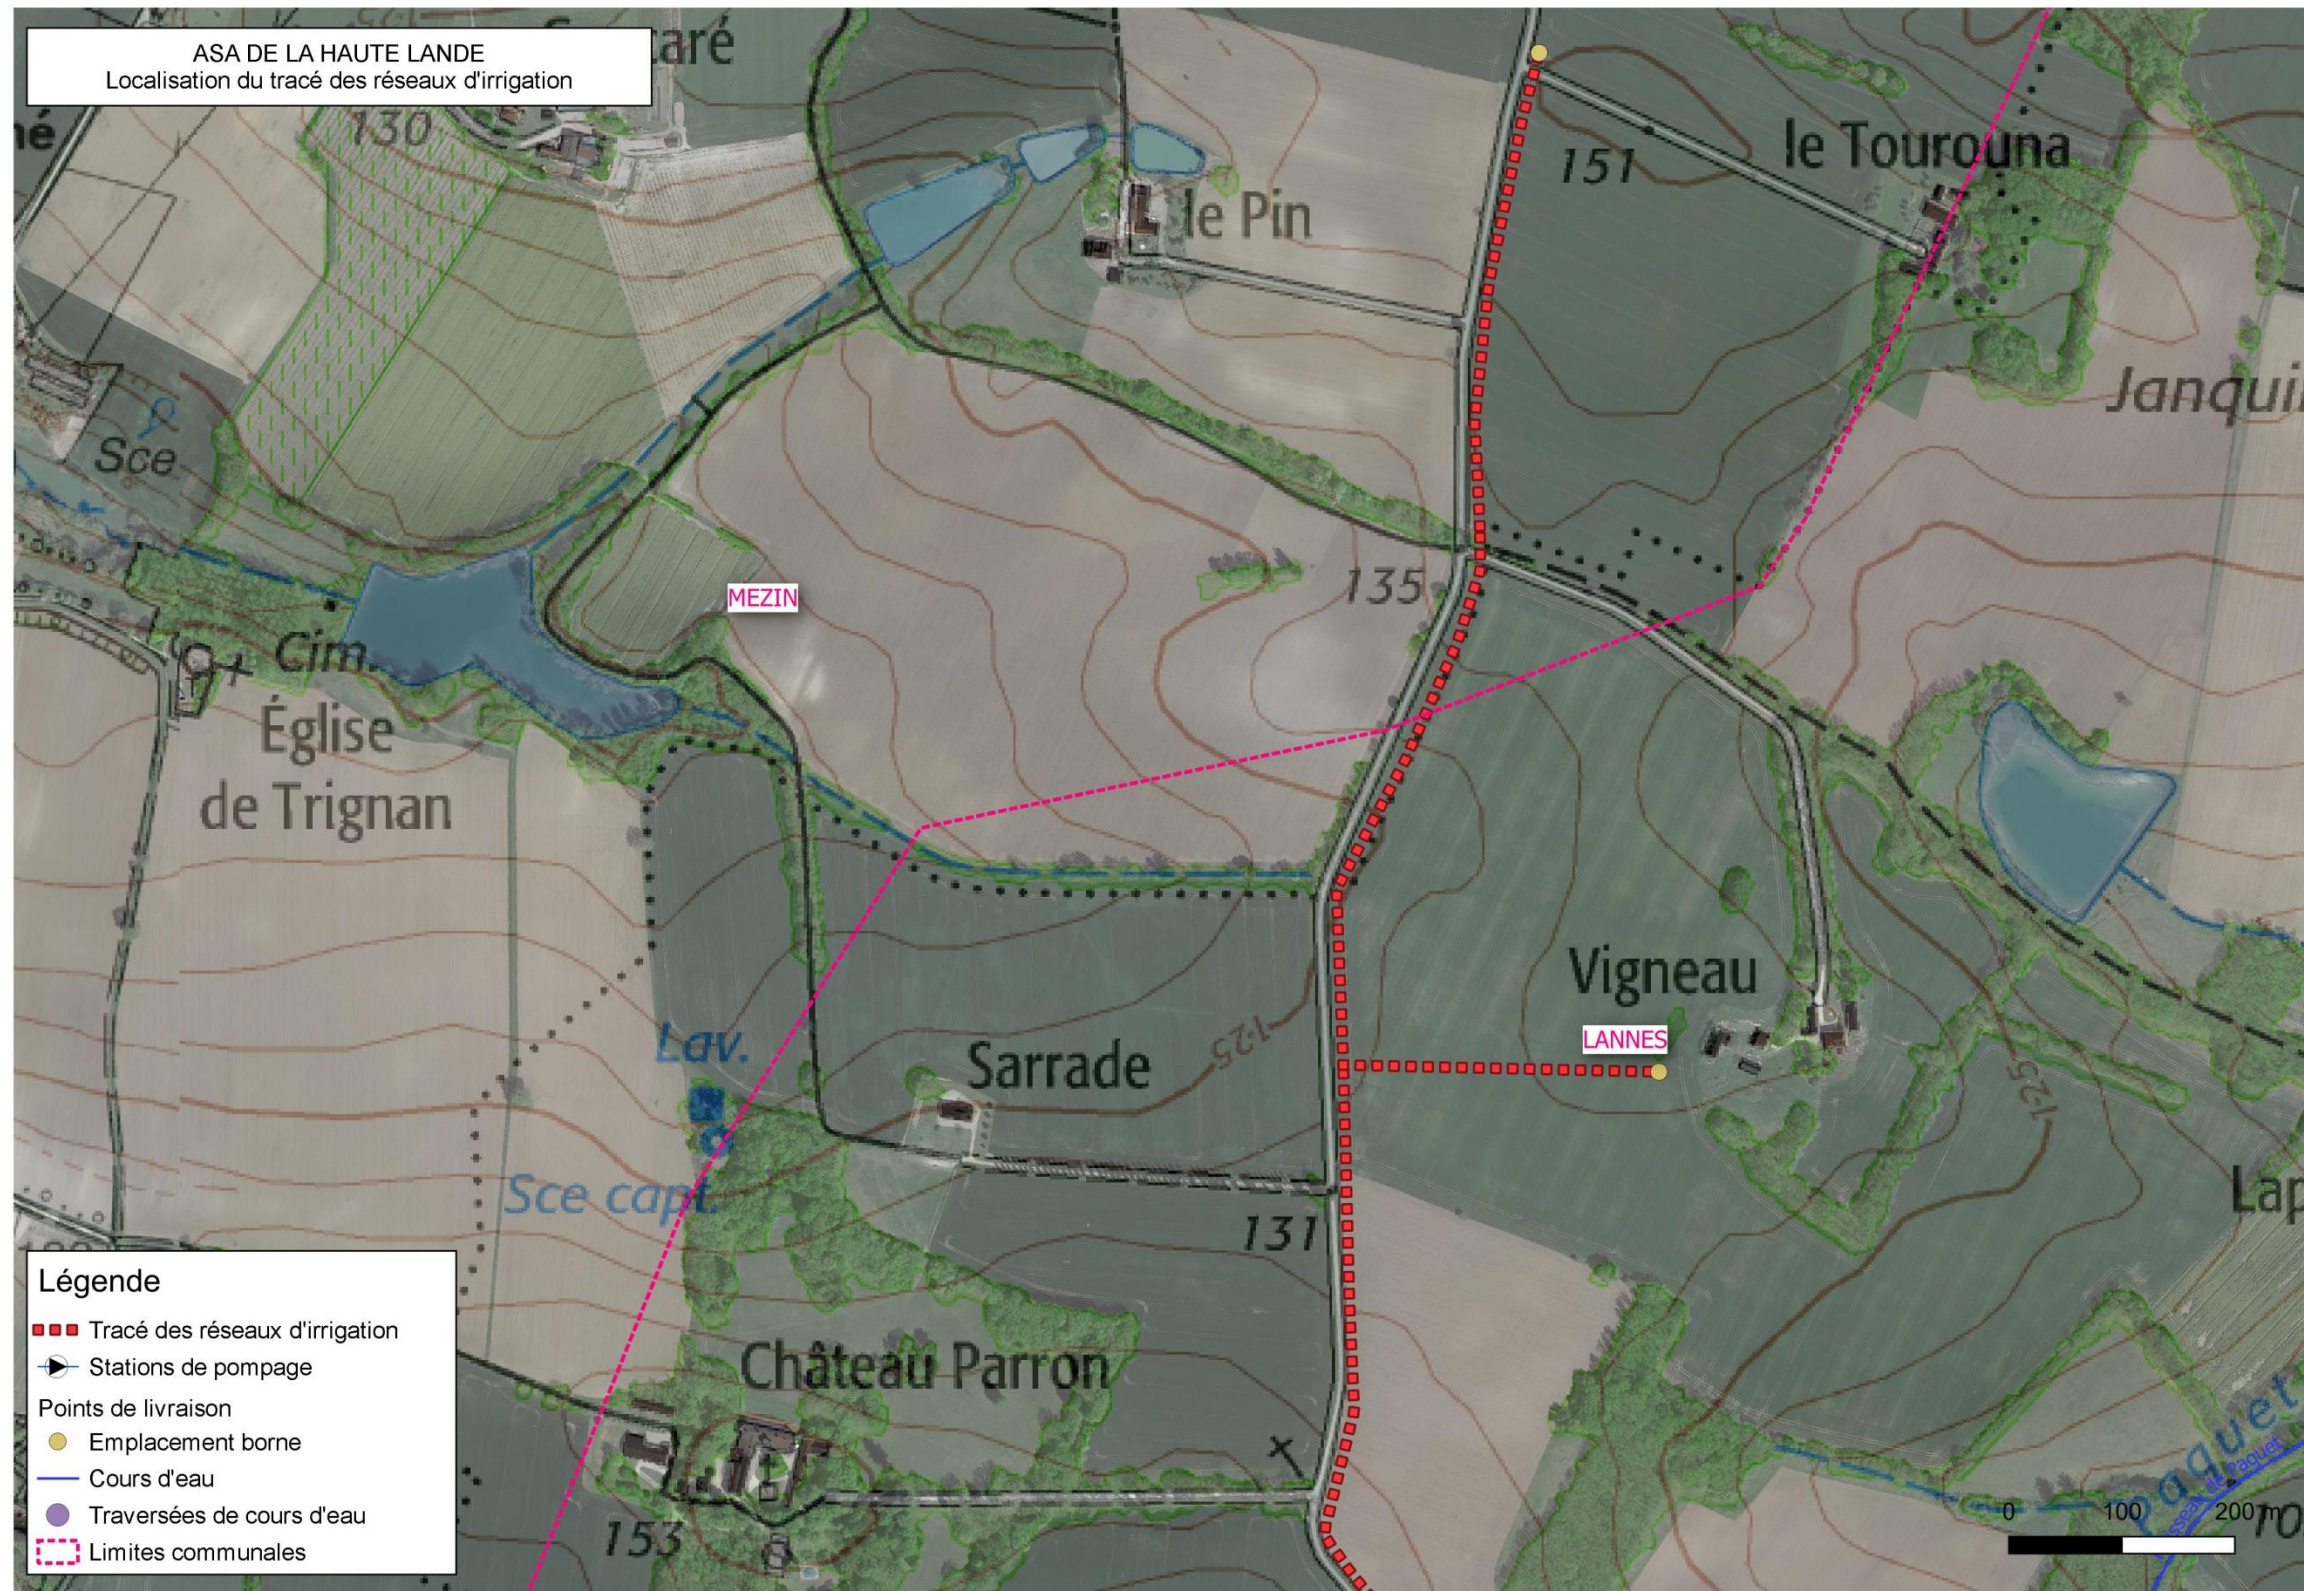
Plan des abords au 1/5000 - planche 3/8
